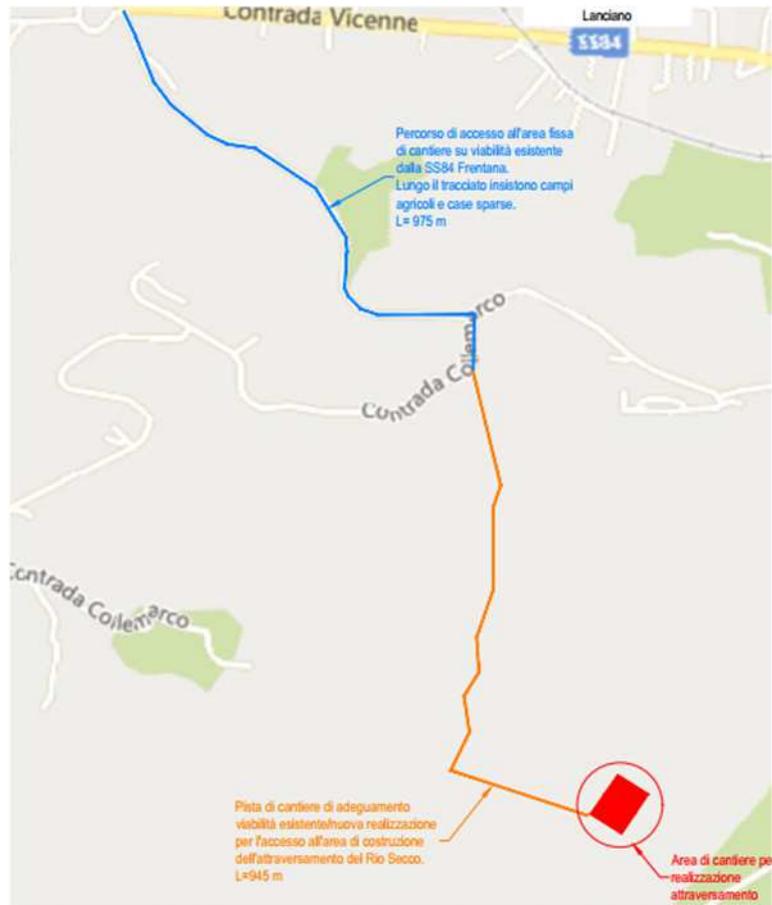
Localizzazione Cantieri Attraversamento N.1 - Stralcio 2
